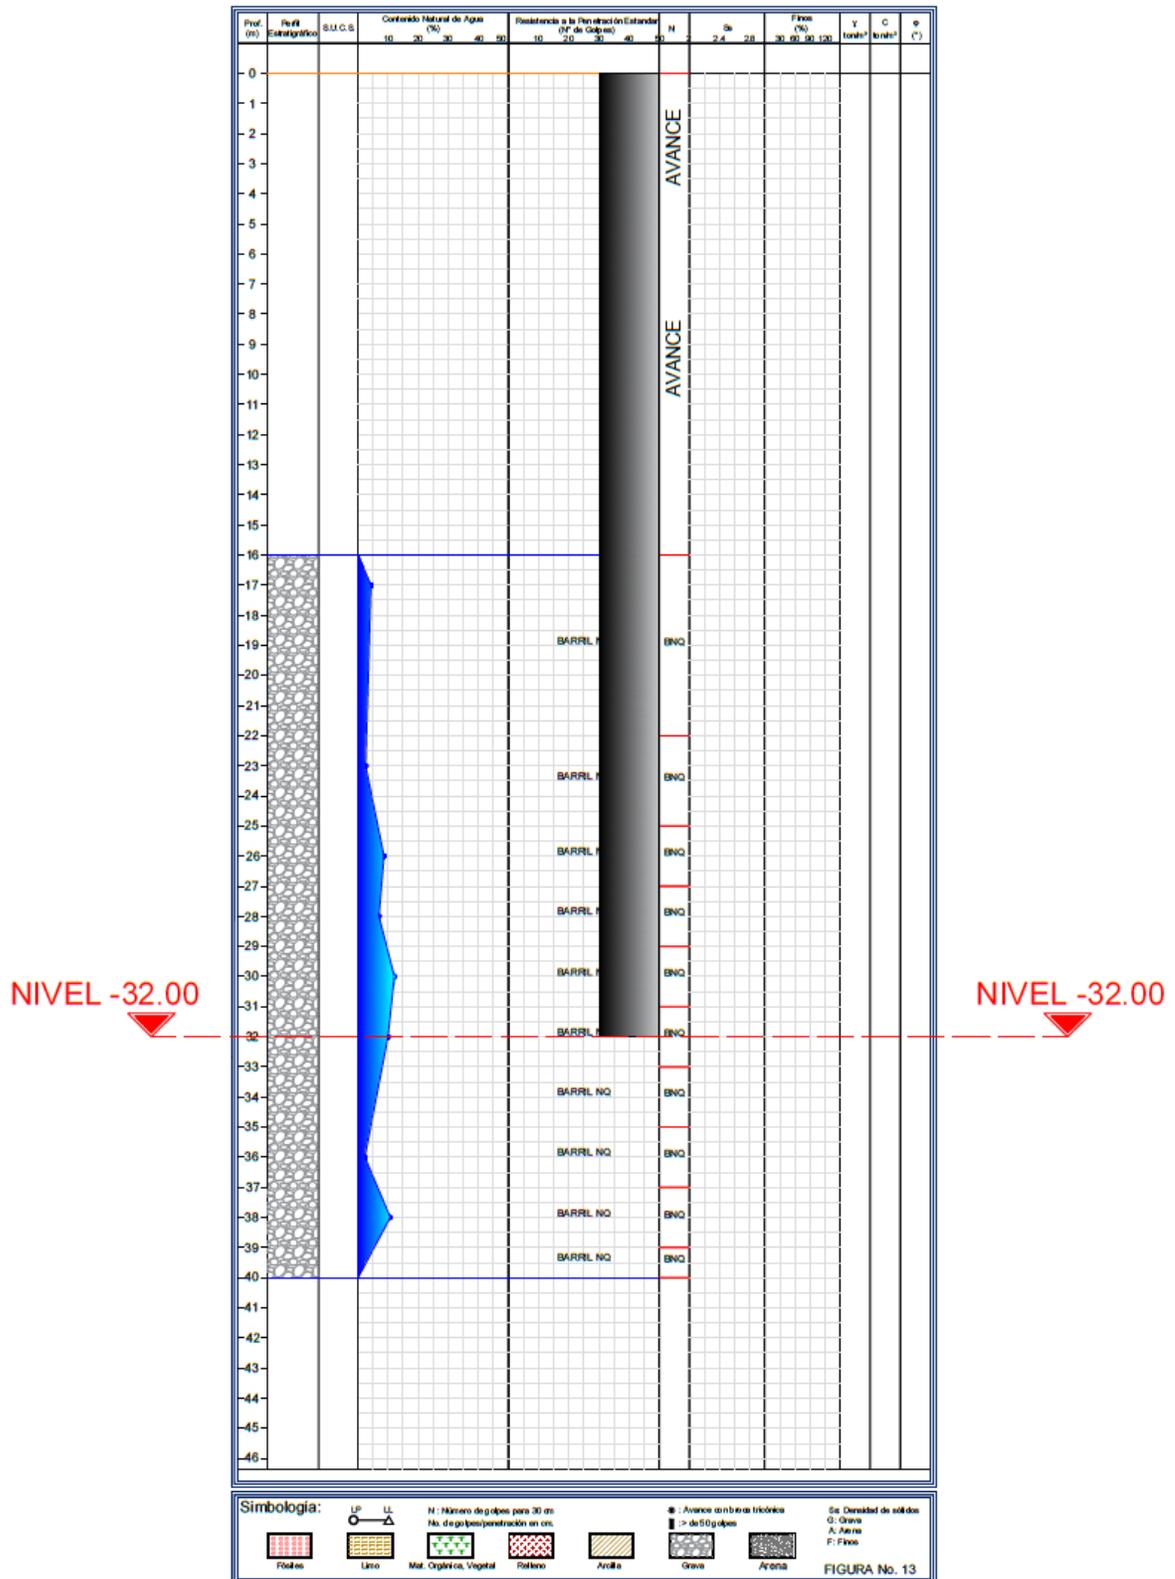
DESPLANTE DE PILA 3 (SM-3-EJE F4).
